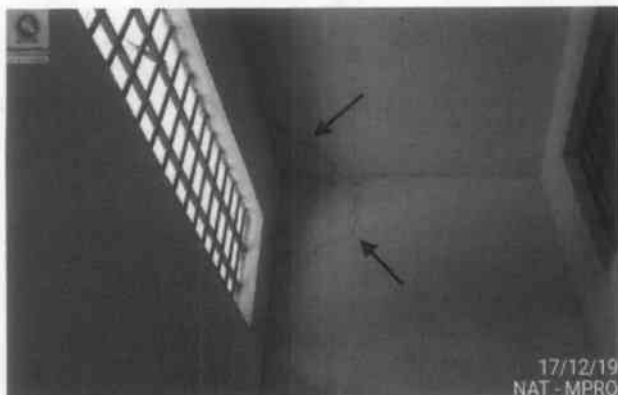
Pavilhão B – rachadura na laje e paredes de concreto.
